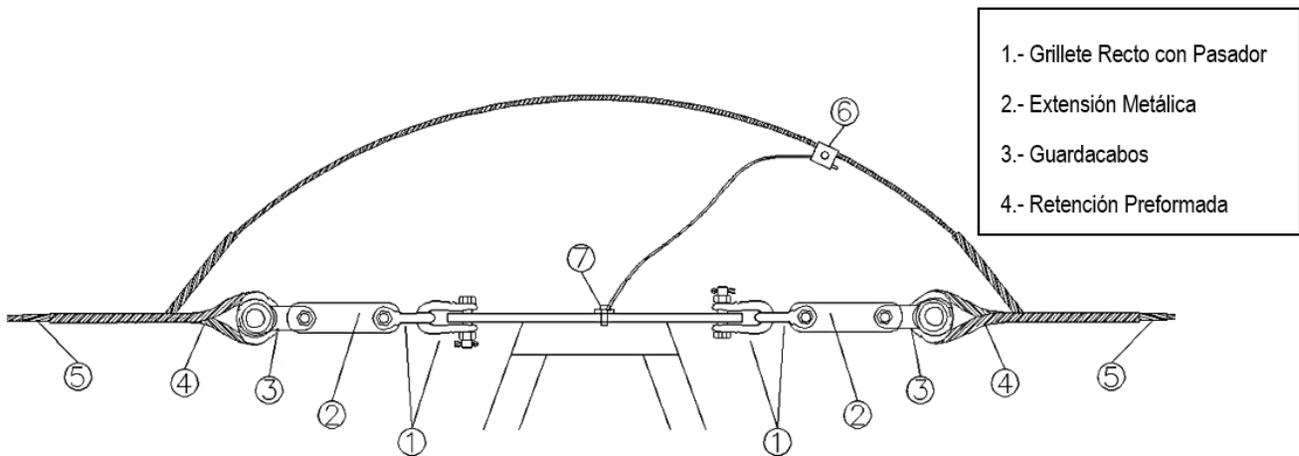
Referencia de conjunto de amarre pasante de OPGW para ser instalado en los 2 extremos de la torre
